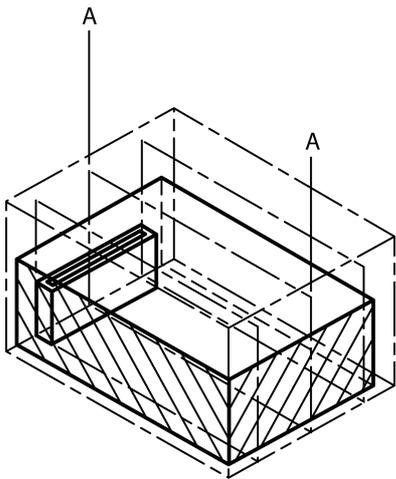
Diffuseur (ou ventilo-convecteur) en allège ou au sol – Exemple de plans d’essai
